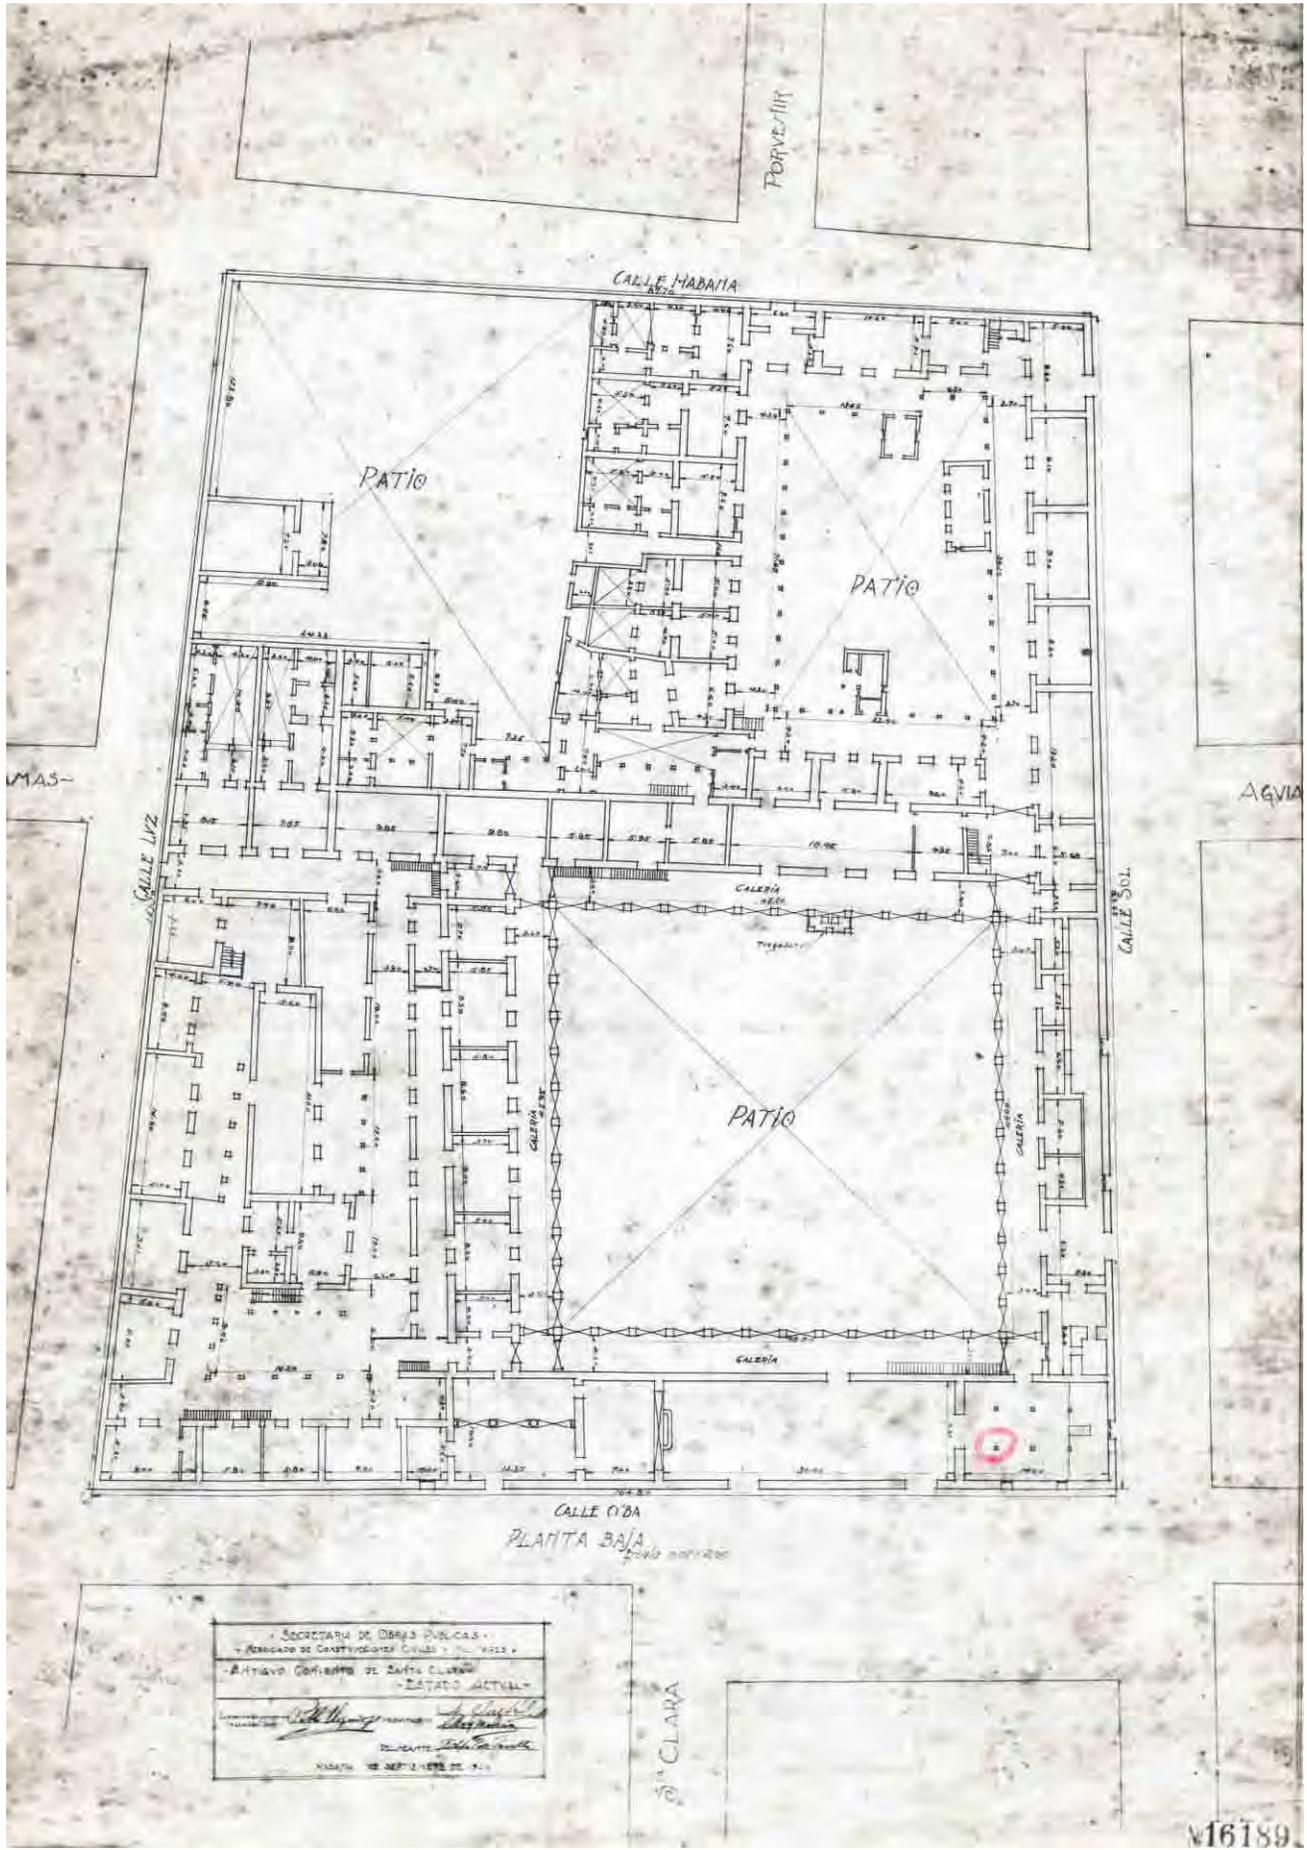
Plano del antiguo convento de Santa Clara de Asís levantado en 1924 por la Secretaría de Obras Públicas
